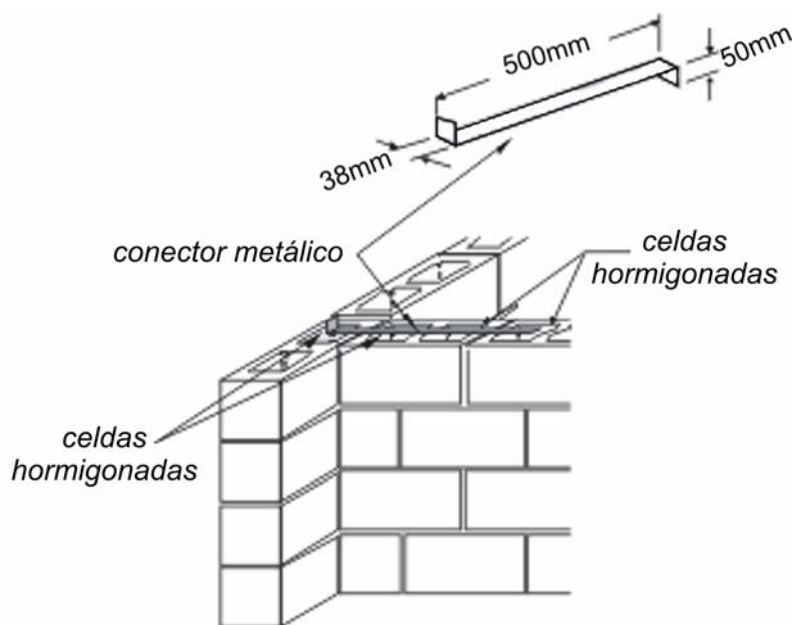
Conector metálico y hormigonado en las intersecciones de muros
